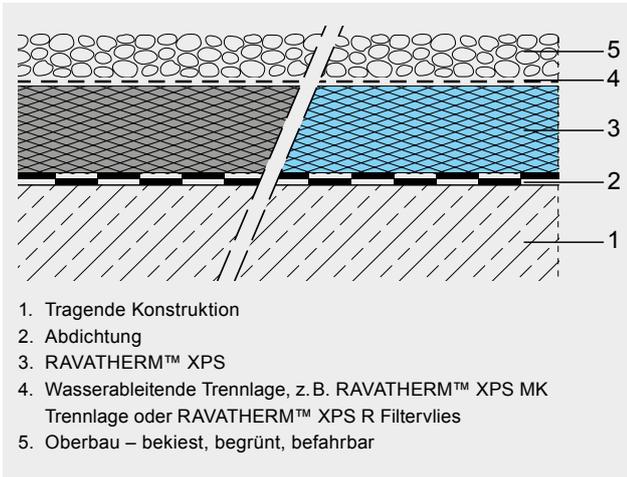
Schichtenaufbau im bekiesten Umkehrdach mit einer bituminösen Abdichtung
